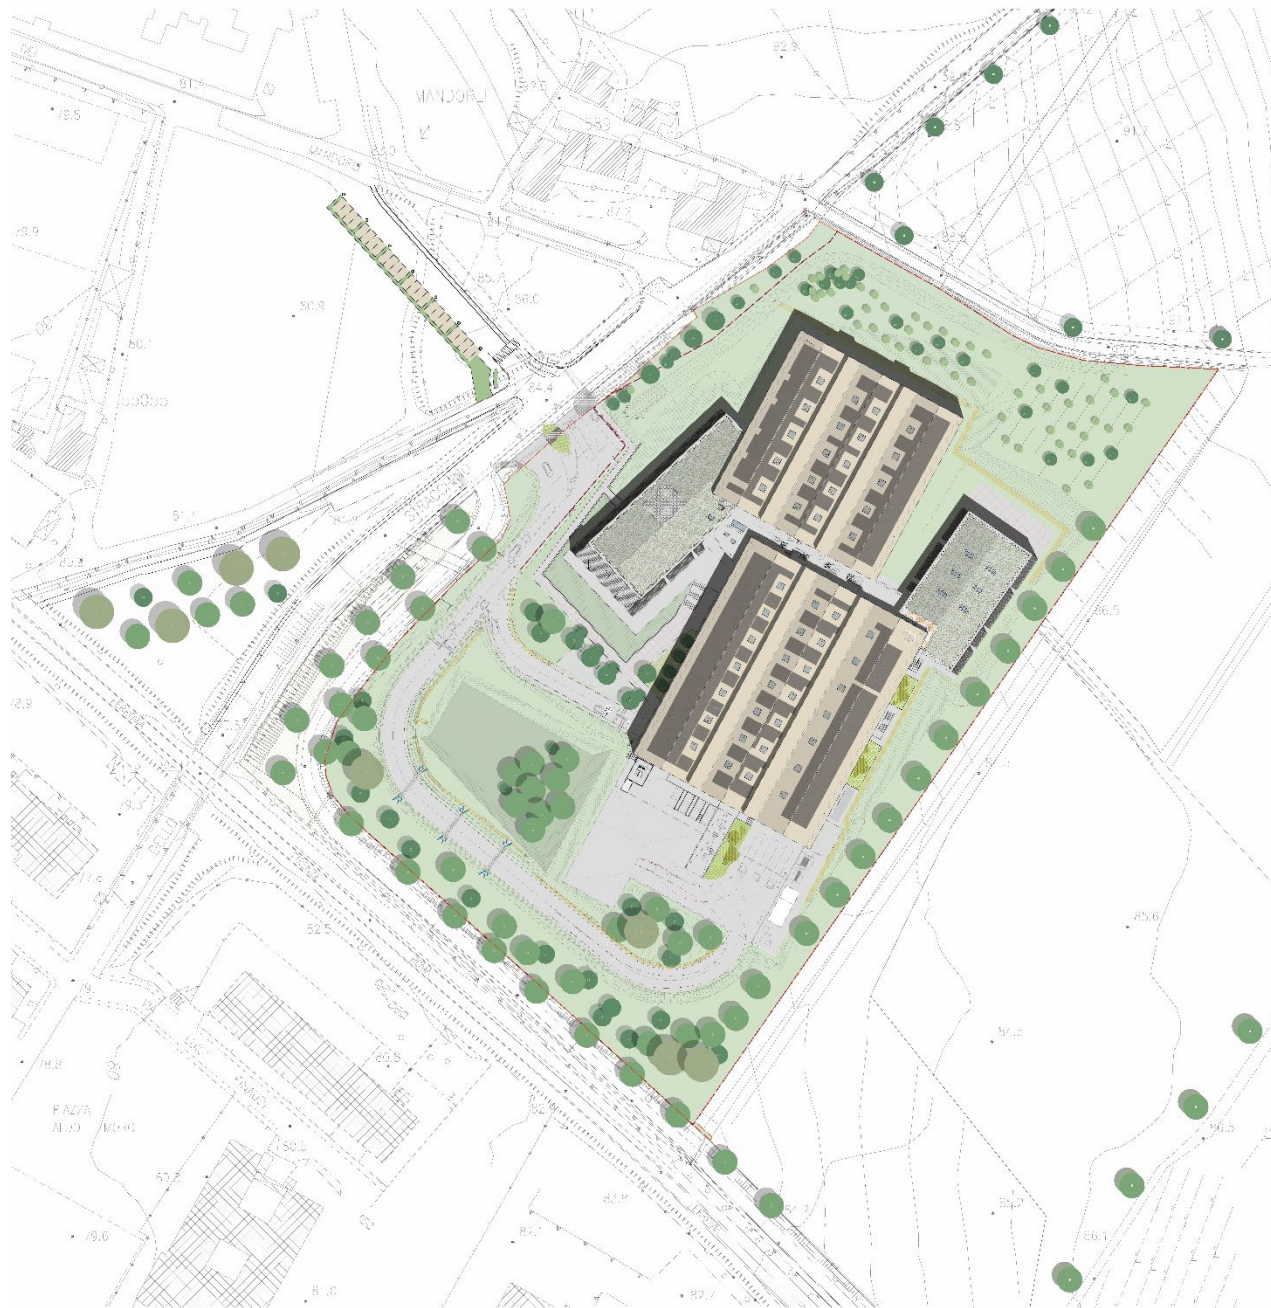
Planivolumetrico R.01 del Progetto Unitario
